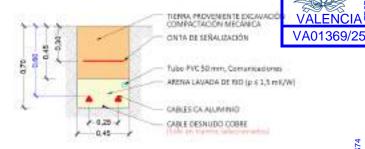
Ejemplos de zanjas tipo de BT y MT.
